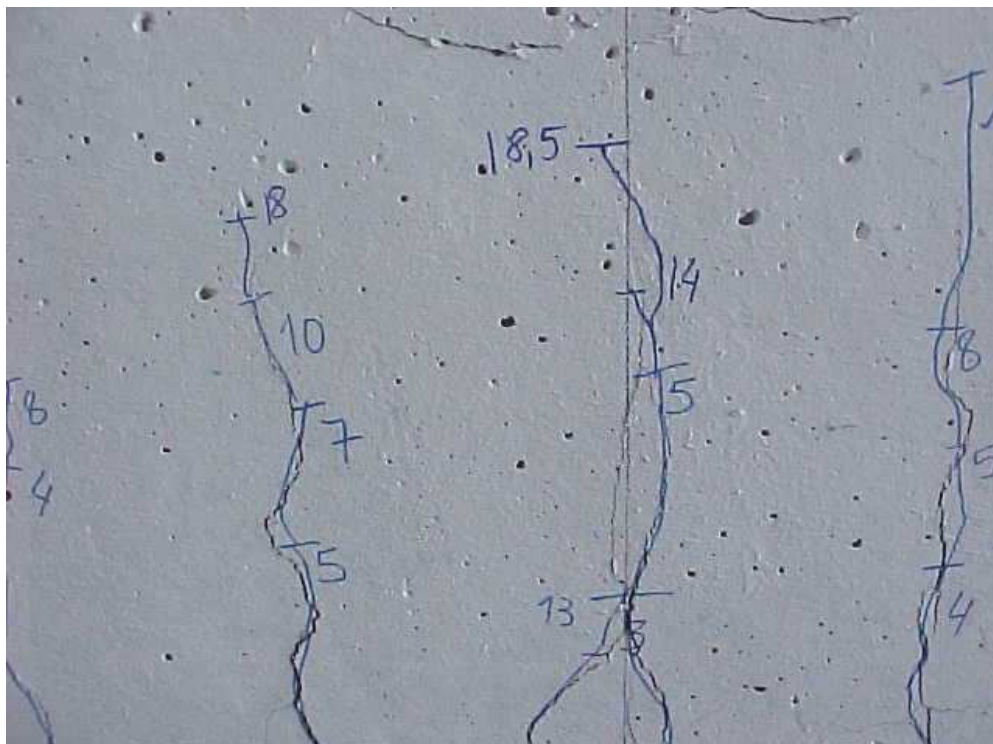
Vista lateral. Progressão das fissuras na região central da viga
